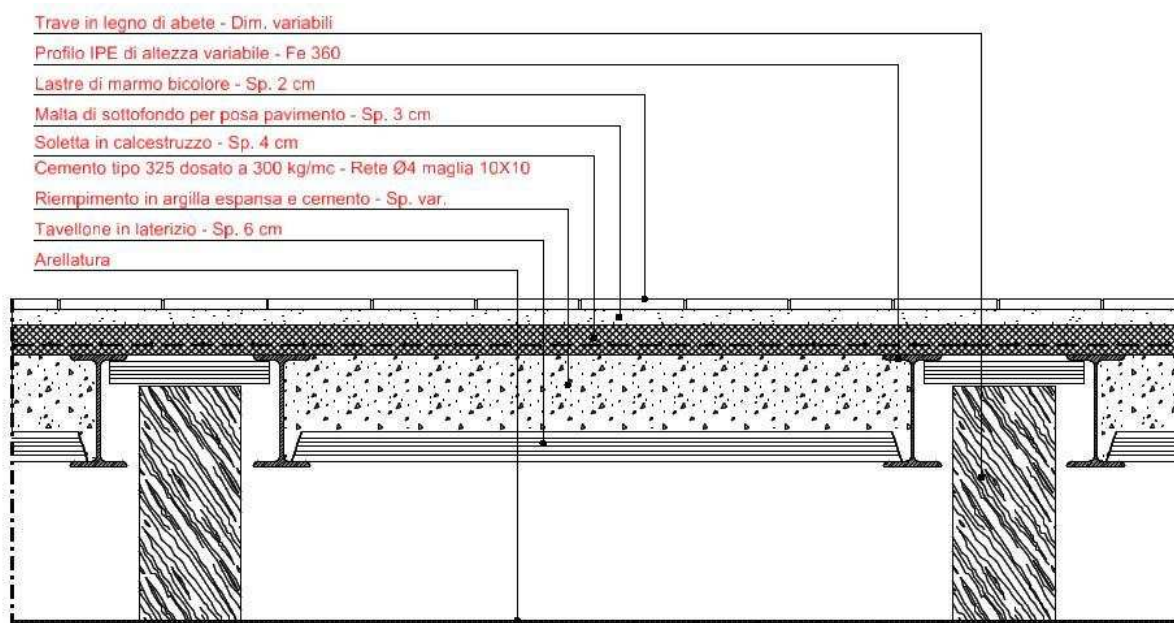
particolari costruttivi dei strutture in elevazione del primo impianto
